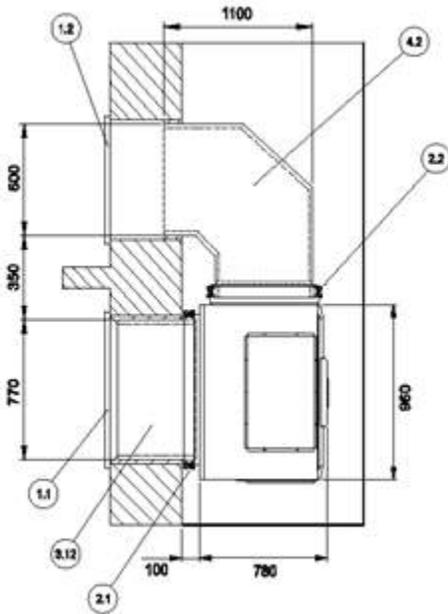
Wandaufstellung mit Luftkanal Ausblasseite - Draufsicht
